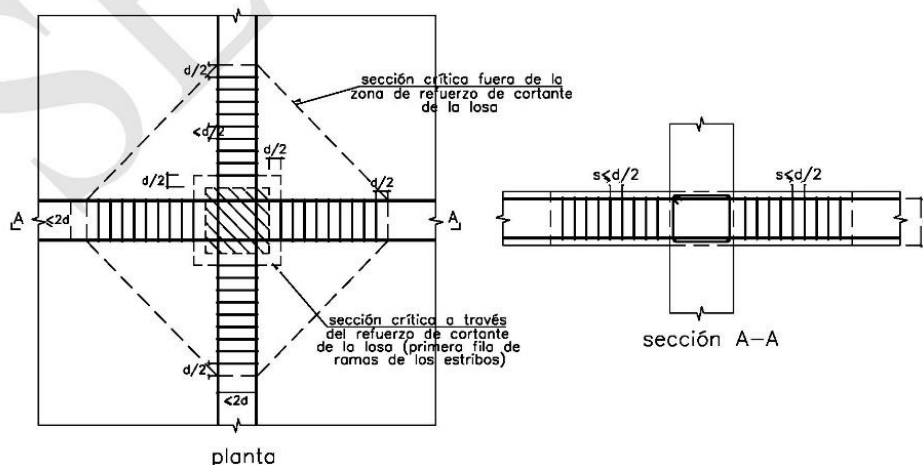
a Disposición de los estribos por cortante en columnas interiores.
